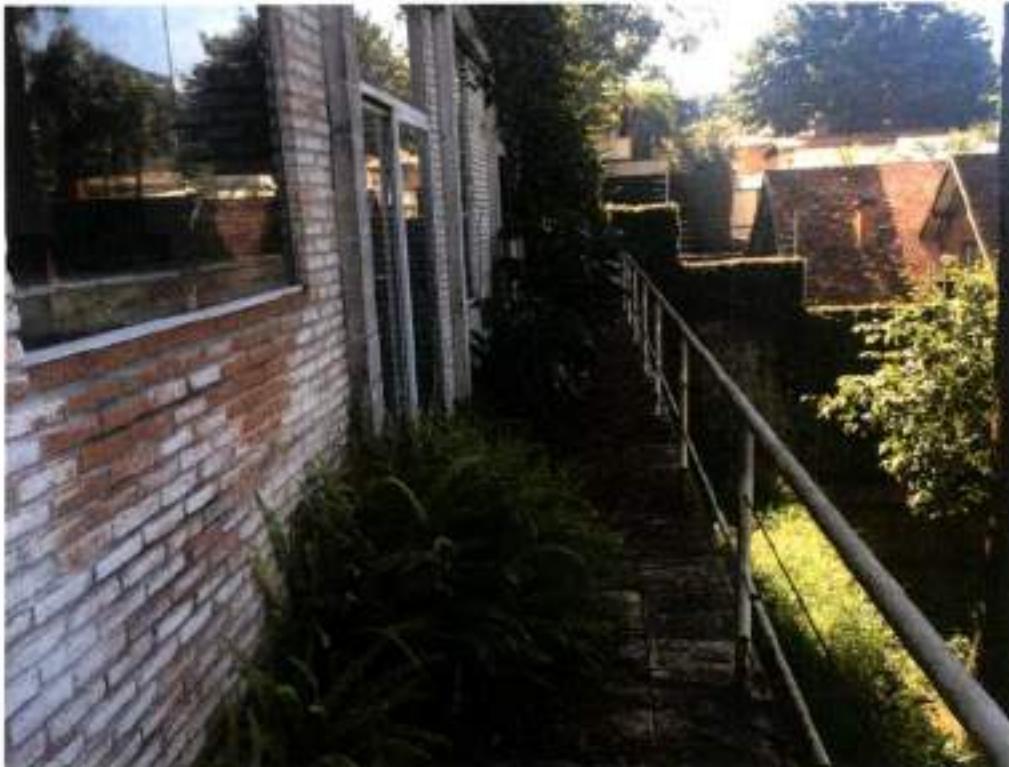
Vista de parte da fachada de fundos da edificação anexa. Notar a grande presença de vegetação.
